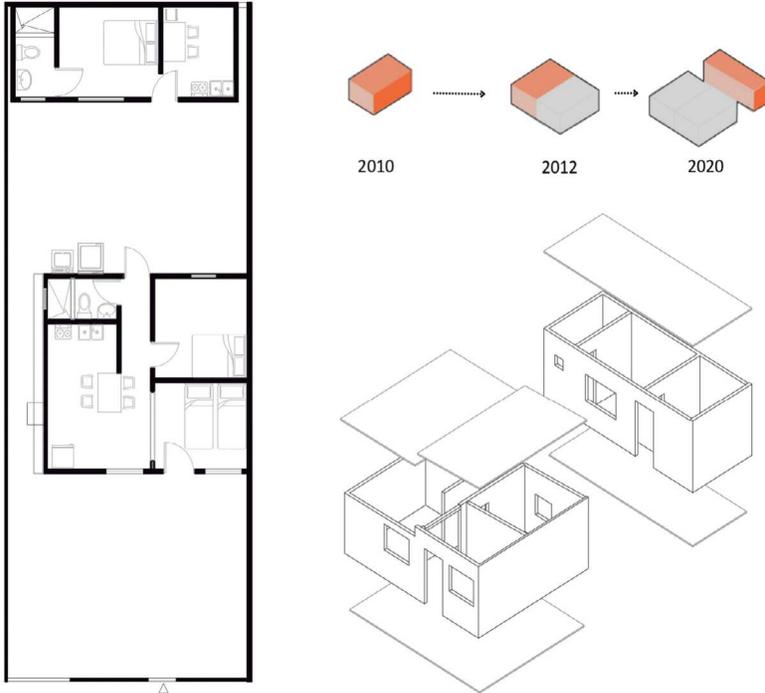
Vivienda construida en etapas, con sistemas constructivos diversos. Fuente: Autor.
